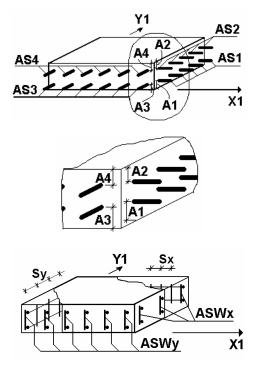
Армирование элементов* железобетонной оболочки
